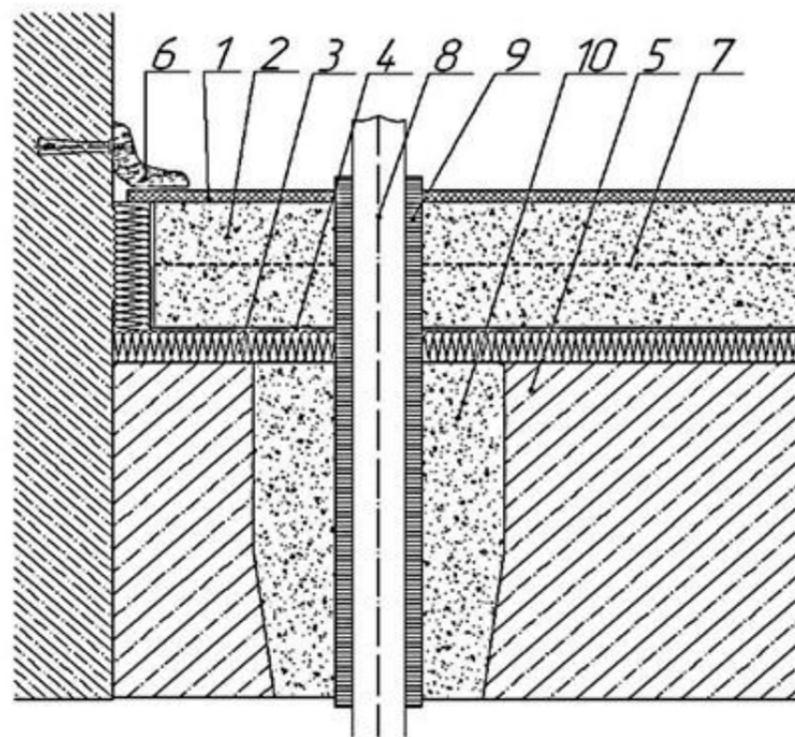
Схема конструктивного решения узла пропуска стояка отопления через междуэтажное перекрытие:
